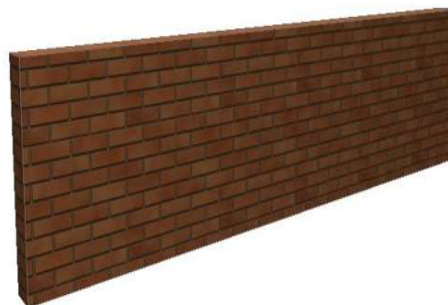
Muro de ladrillo. Elaboración: del autor. Año: 2017.
